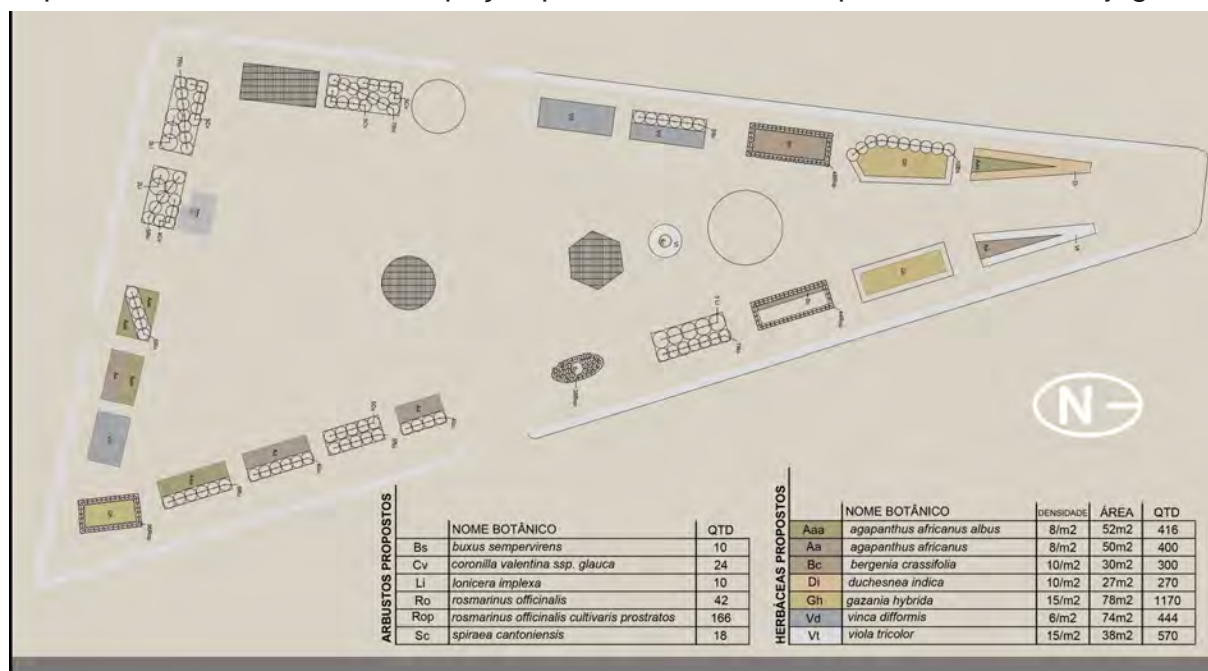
Plano de plantação do . S/ escala. Fonte Autor
